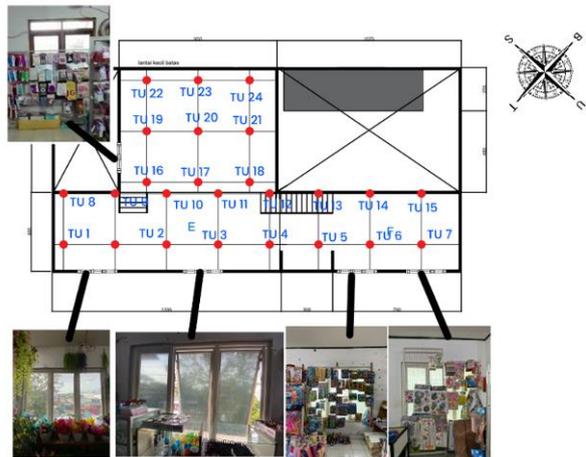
Mezzanine lantai 2 Sumurboto Stationery
